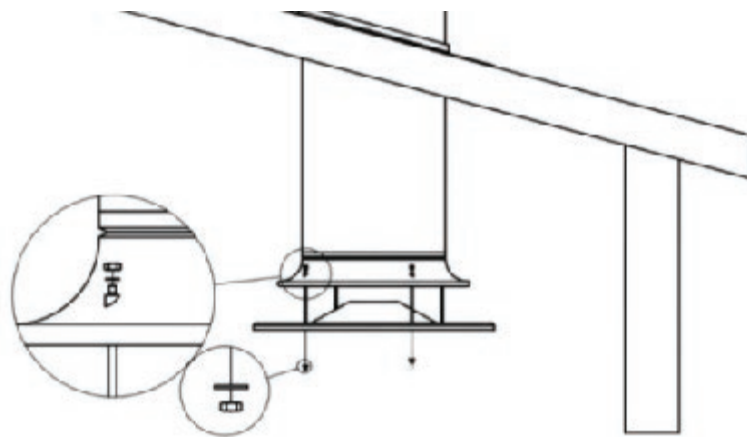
Instalace střešní chladicí jednotky ROOF COOLER
